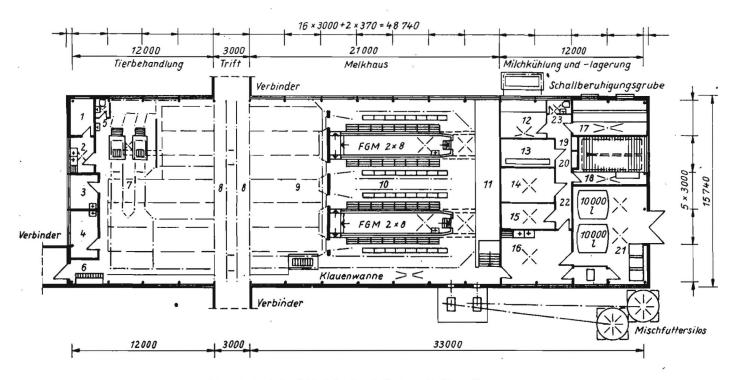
Grundriß des Angebotsprojekts "Melkhaus 2 × 2 × 8 (6) mit Tierbehandlung"; Systemmaße 15 m × 48 m
